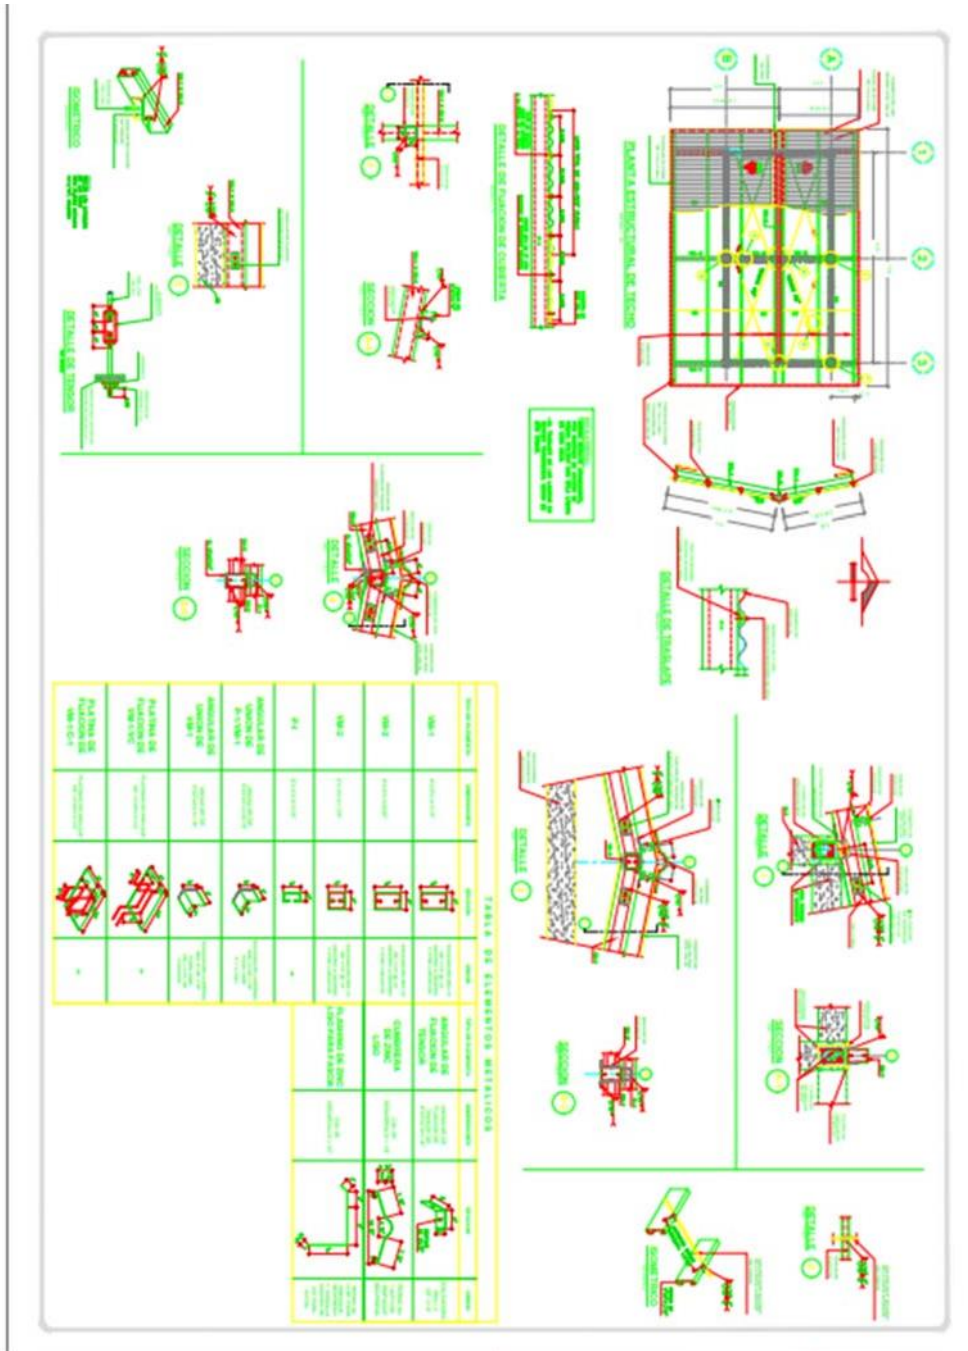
Planta estructural de detalles de techo de servicios sanitarios
